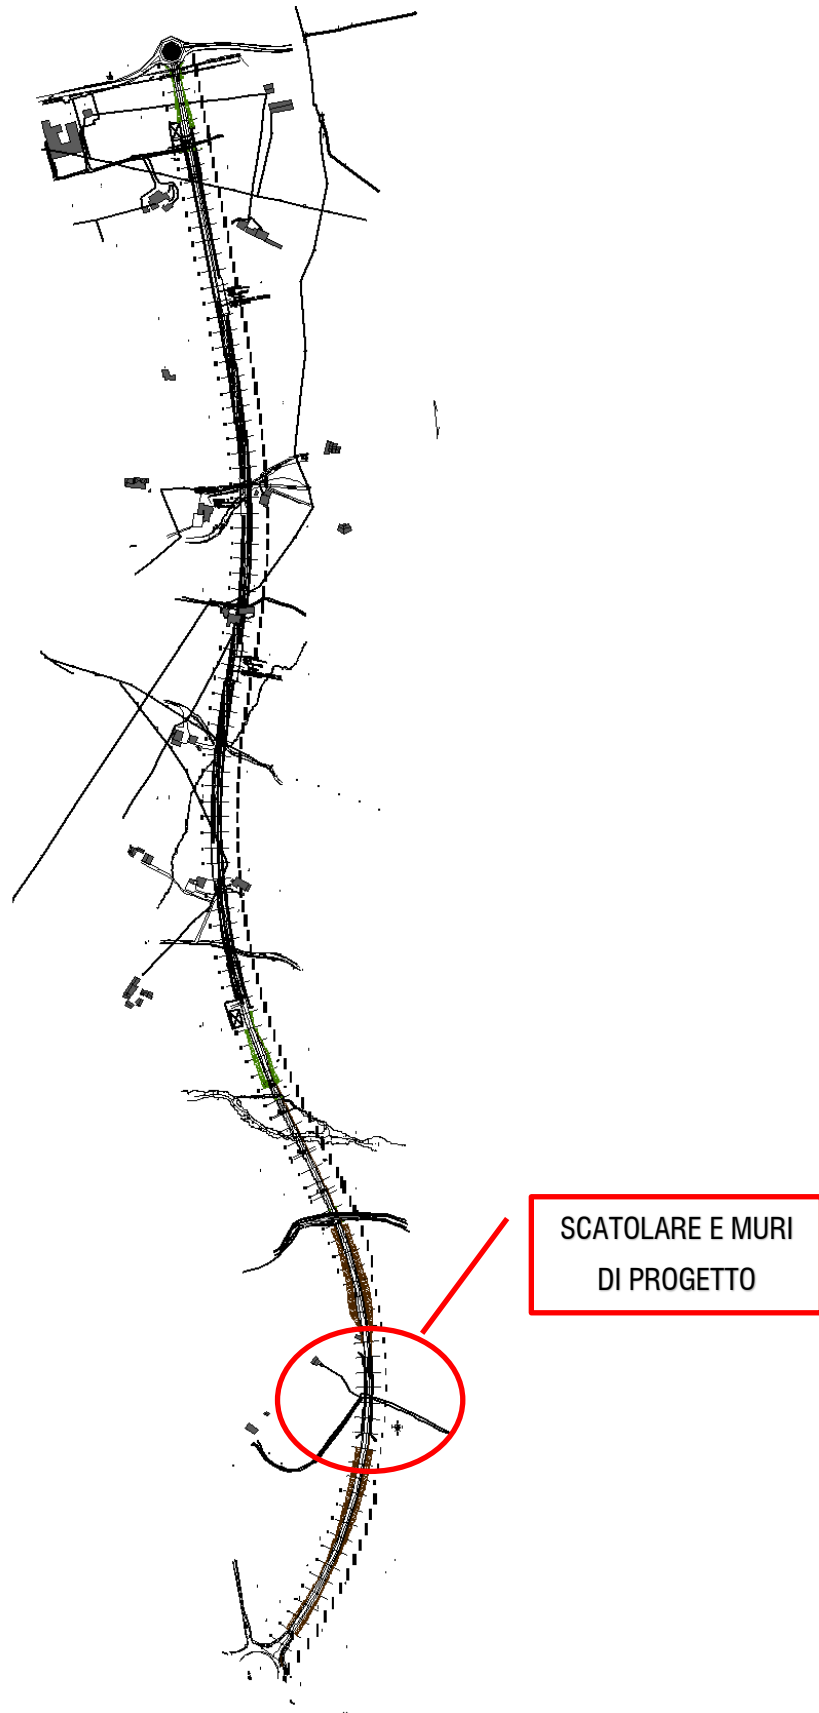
andamento planimetrico tracciato e ubicazione scatolare & muri.
